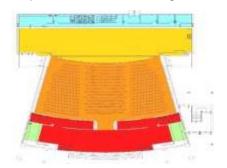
Plantas do primeiro piso. Fonte: Calor, 2004.
